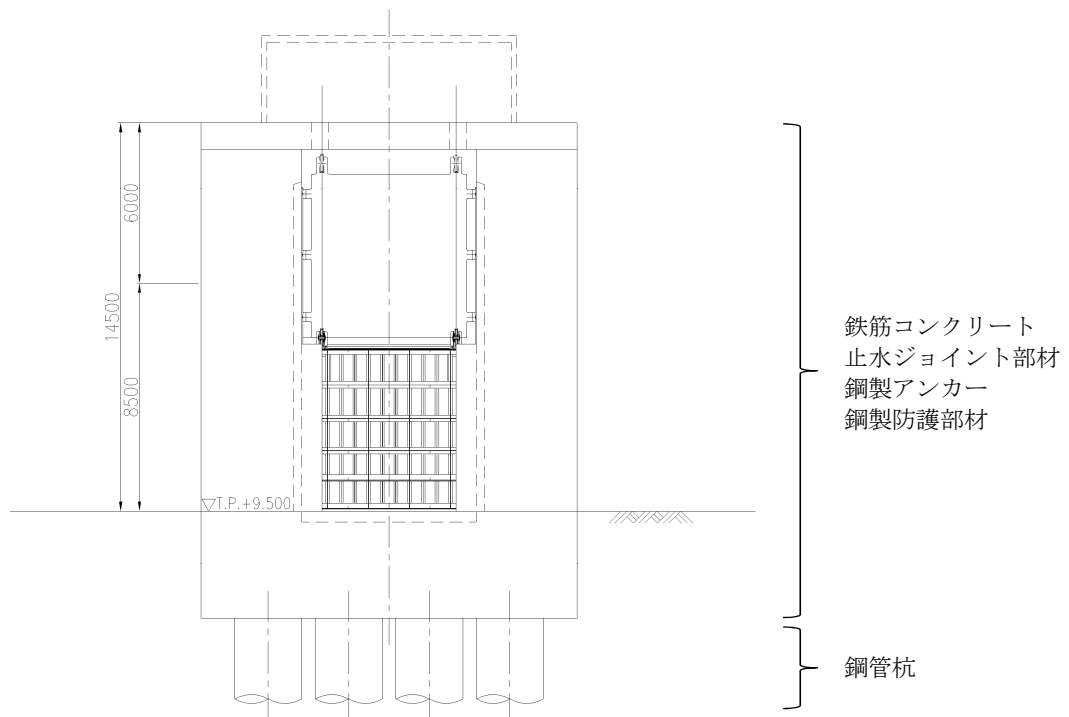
鉄筋コンクリート防潮壁正面図（防潮扉2）
